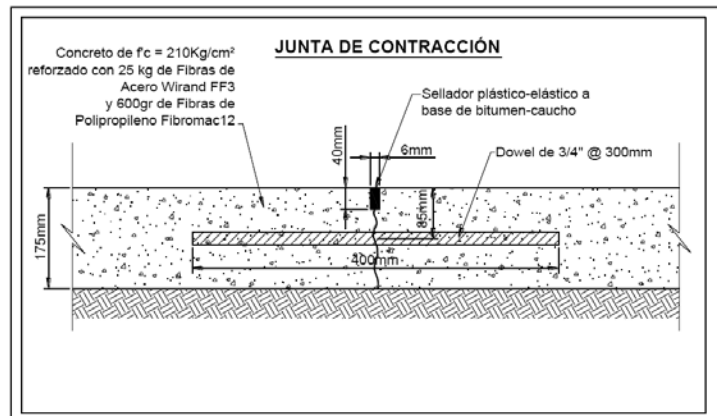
Detalle de junta de contracción con Dowell - Losa de Concreto con Fibras de Acero.
